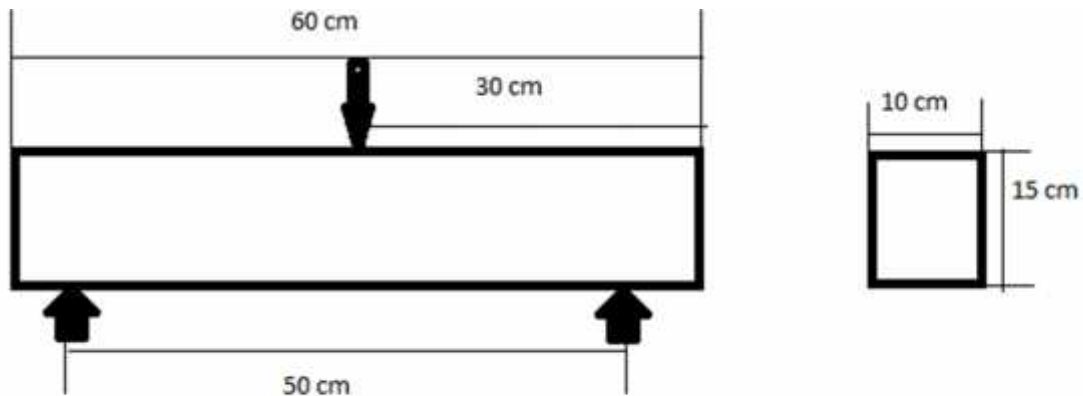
Schéma de la disposition de la poutre sur la machine d'essai
